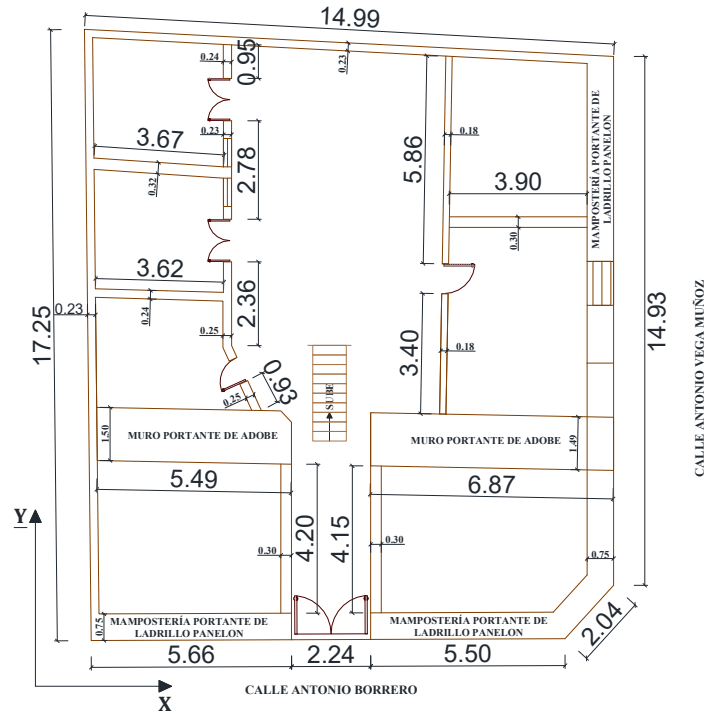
Plano: Vista en planta muros portantes de la edificación en estudio. Fuente elaboración propia
